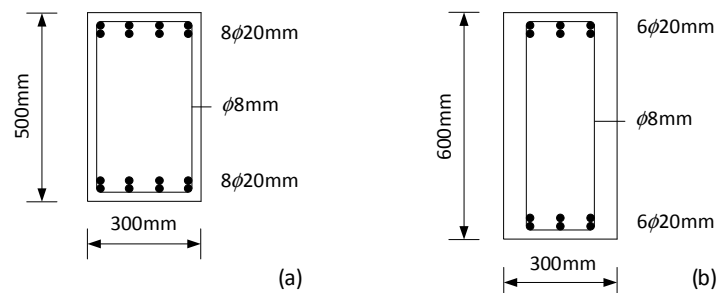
Secções transversais: (a) pilares e (b) vigas.
